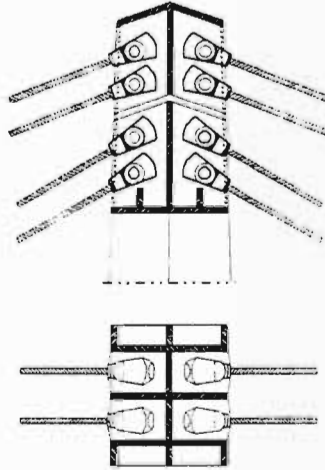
Estructura tipo placa de conexión para el anclaje de los cables en el pilar.
